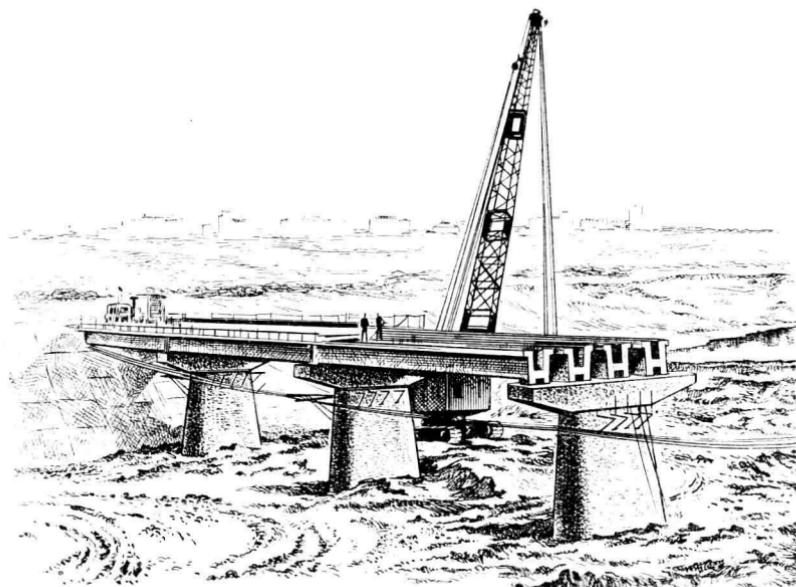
Строительство керамзитожелезобетонного предварительно напряженного моста через р. Ахтубу
